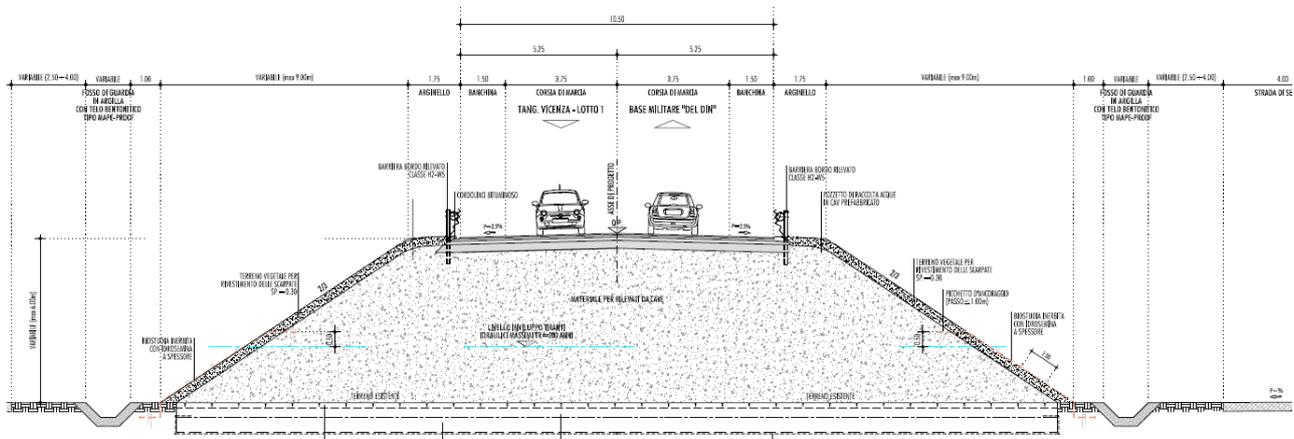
SEZIONE TIPO IN RILEVATO
